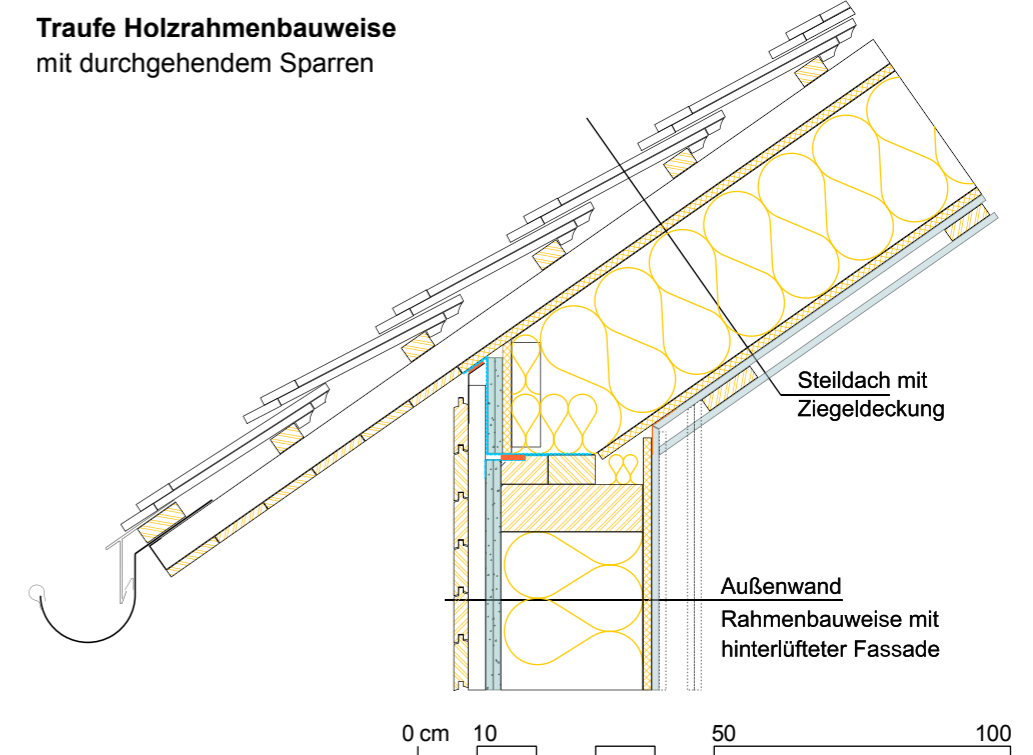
Konstruktionsdetail Traufe Holzrahmenbauweise
